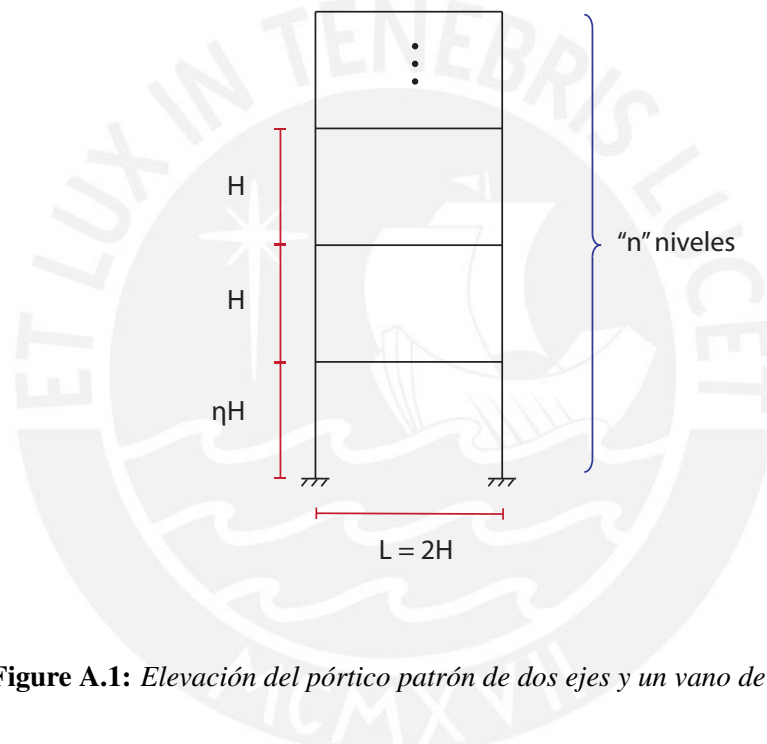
Elevación del pórtico patrón de dos ejes y un vano de n niveles
